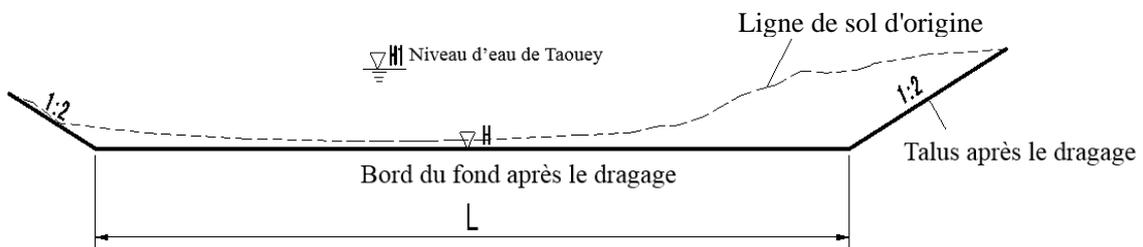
1 Coupe typique de l'expansion du canal de la Taouey
